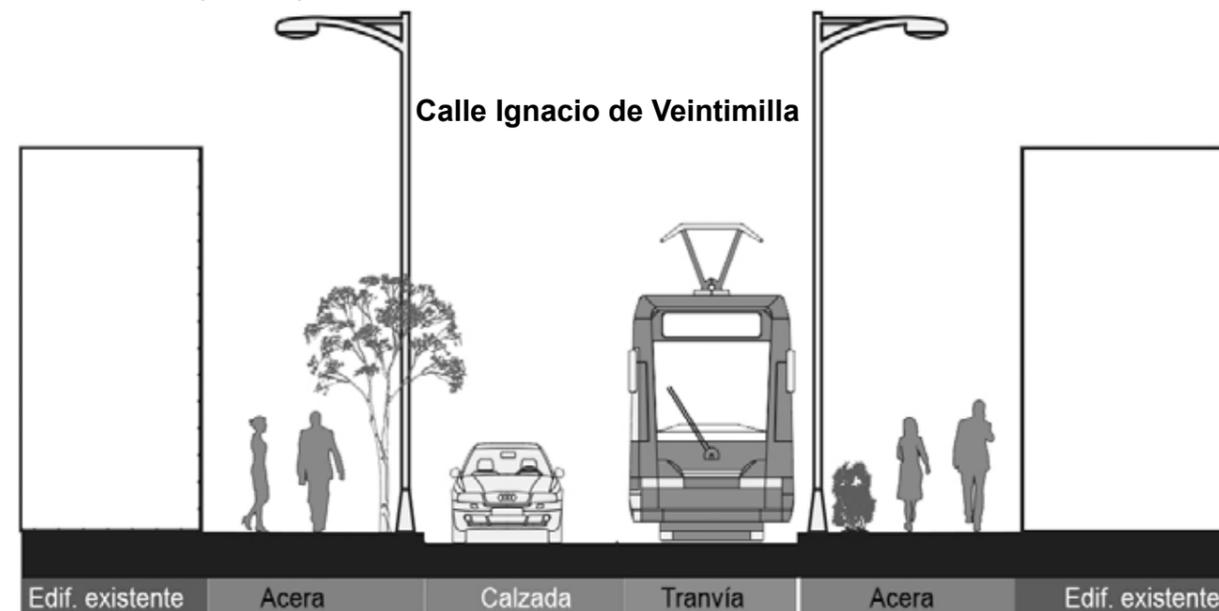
Ancho de aceras propuesta Tomado de (POU, 2017, p 530).
